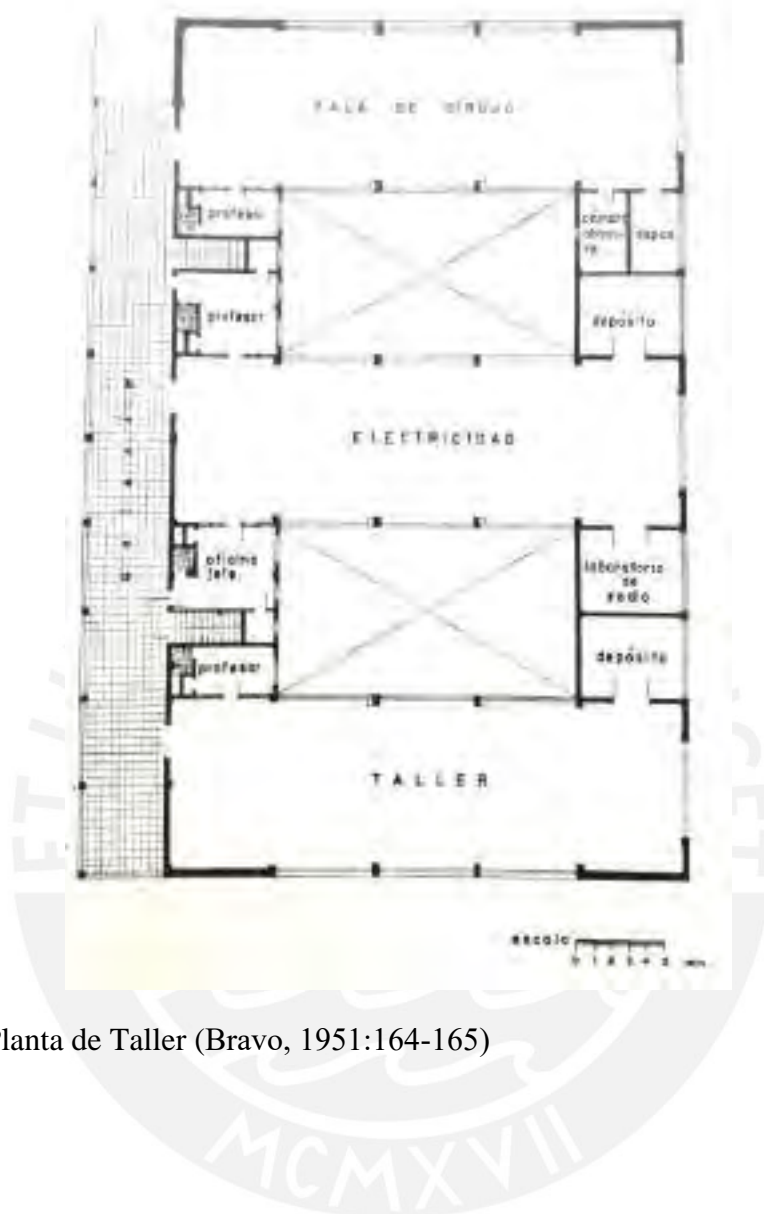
Planta de Taller (Bravo, 1951:164-165)
